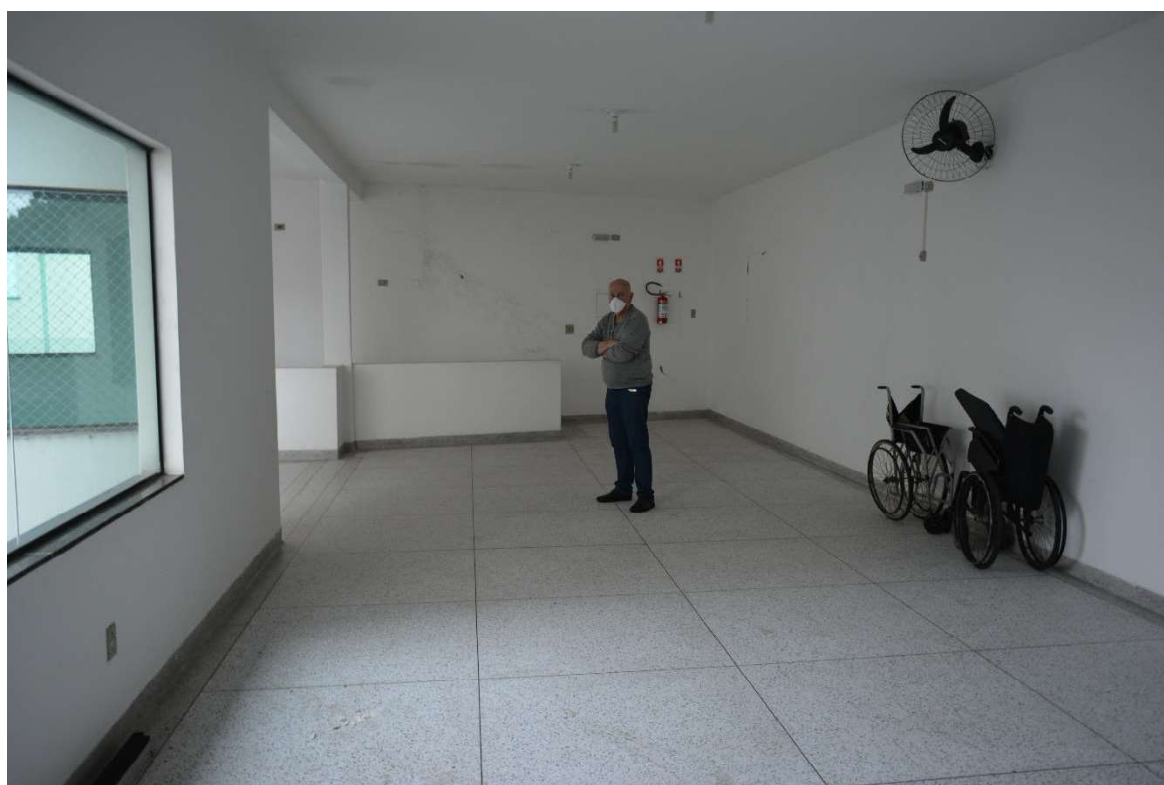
VISTA DA LATERAL DO SALÃO DE FESTAS.
